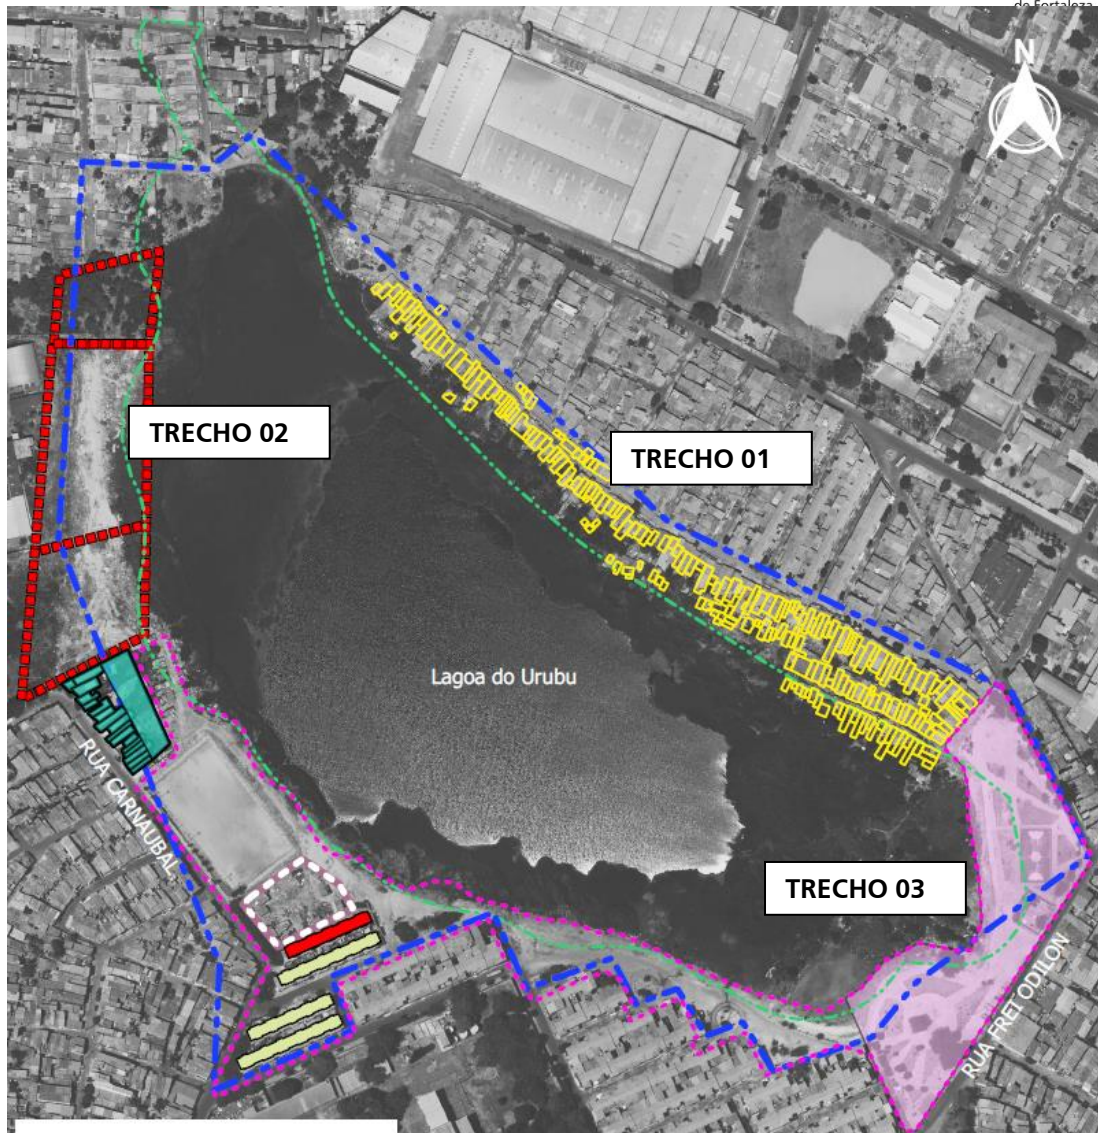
Levantamento Trechos de obra - Intervenção Lagoa do Urubu
